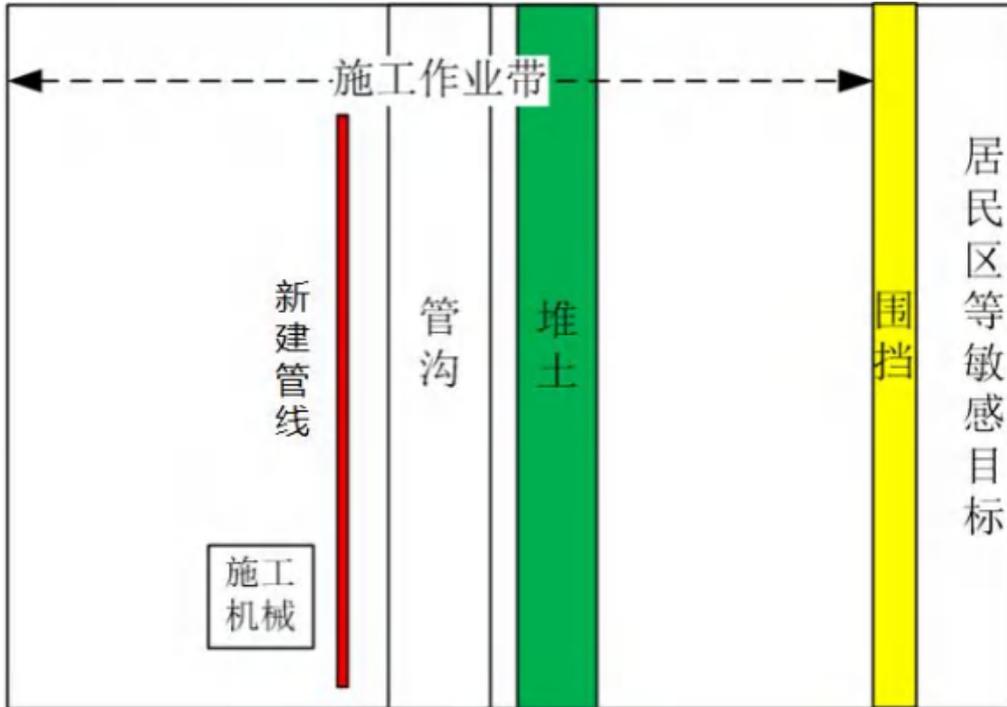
一般开挖段管线施工区域平面布局示意图
